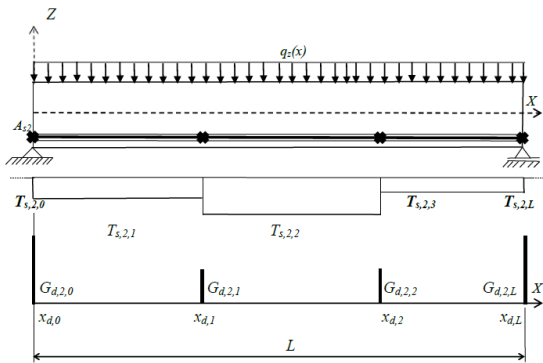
Схема железобетонной балки с дискретным закреплением арматурного элемента.
